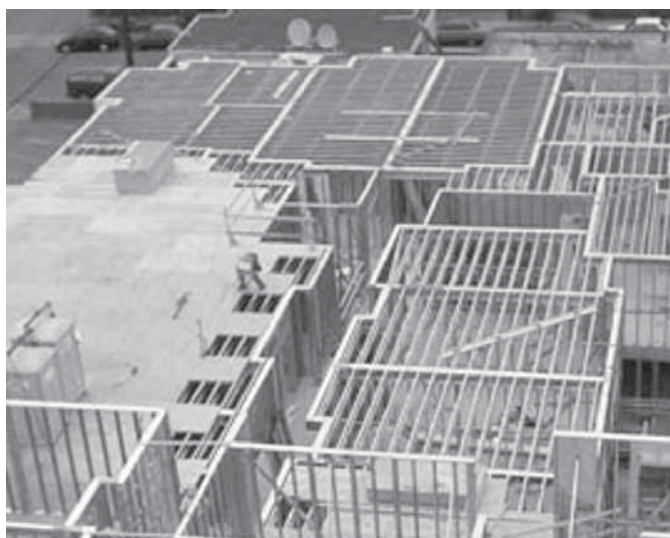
Estrutura de piso em Light Steel Framing (Fonte: disponível em: <http://www.aegismetallframing.com>)
